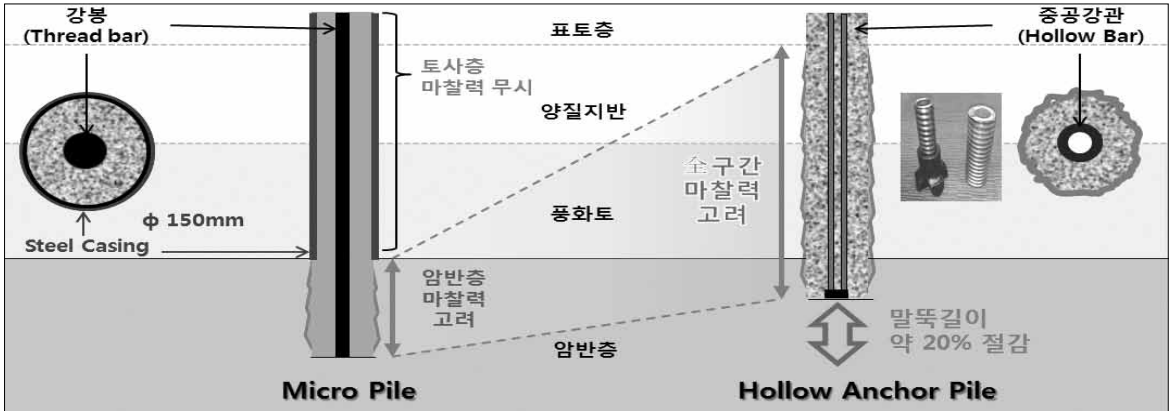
Hollow Anchor Pile 공법 지지메커니즘
